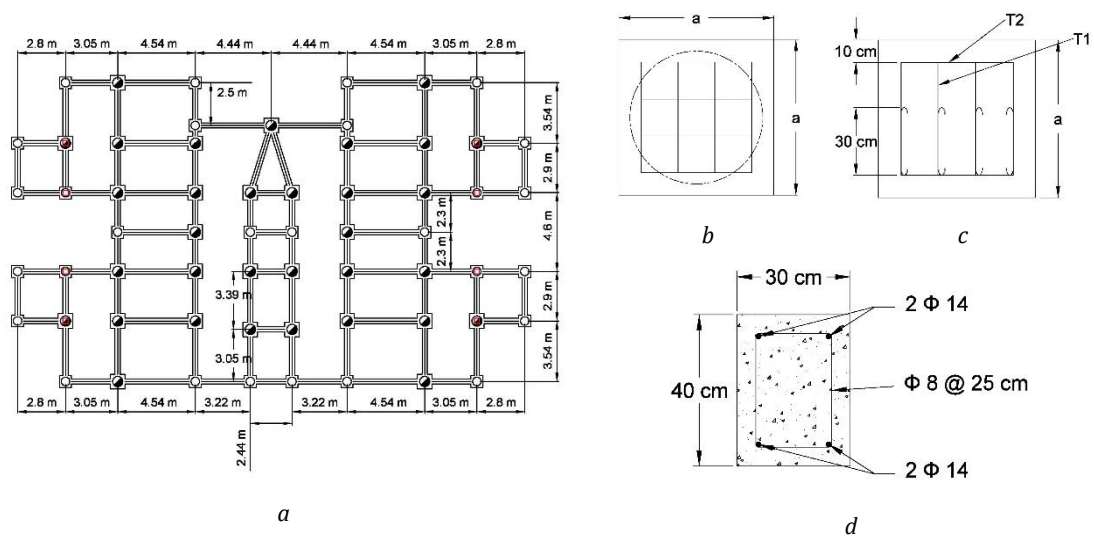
Detalles estructurales del edificio San Fernando -bloque 11- (Lorca). a) detalle de cimentación, b) planta de pilote, c) detalle lateral de pilote, d) detalle de vigas de atado.
